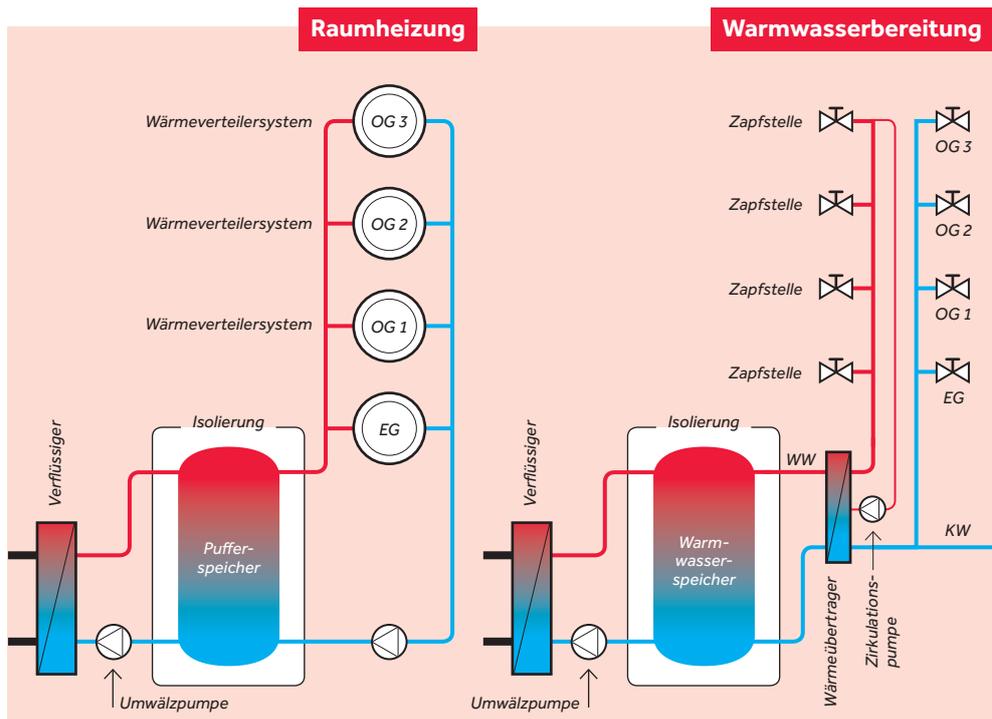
Prinzipdarstellung einer Heizungsanlage mit separaten Wärmepumpen zur Raumheizung und Warmwasserbereitung mit einem zentralem Frischwassersystem *Quelle: AIT 2013
